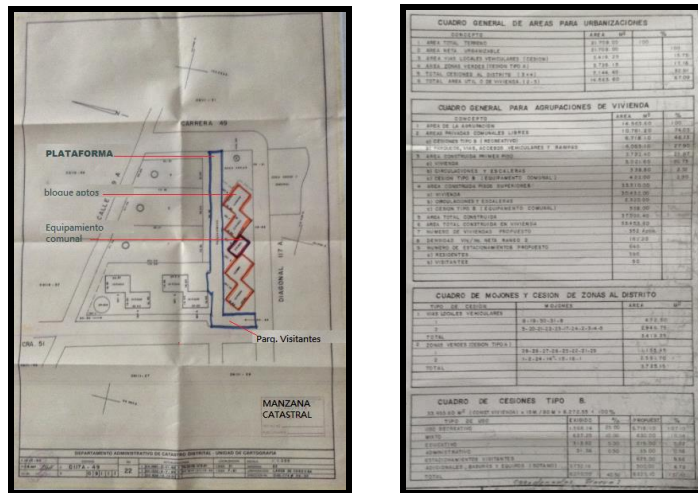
Plano plataforma-cuadro general de áreas. Fuente: construcción de autores
